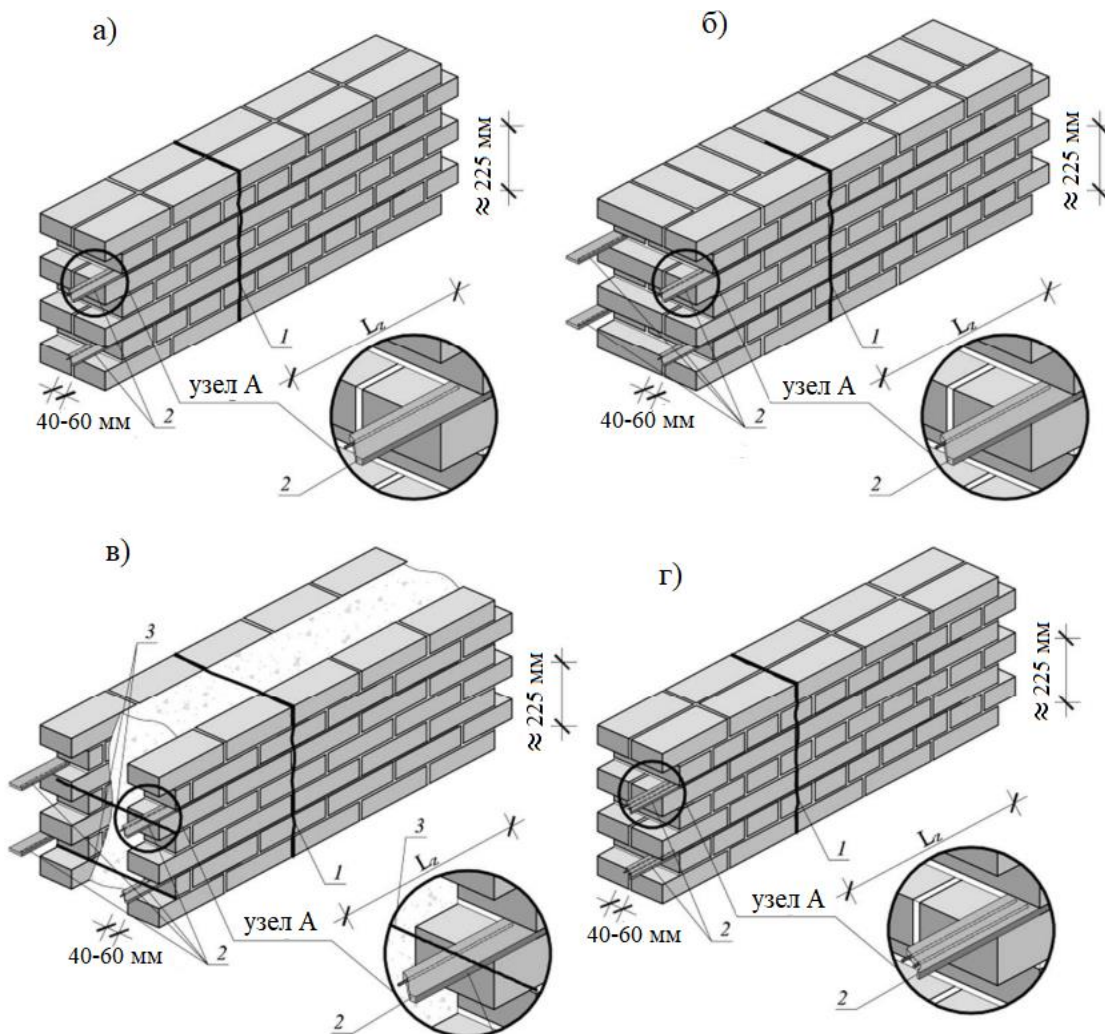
Этапы производства работ по армированию каменной кладки [6]
